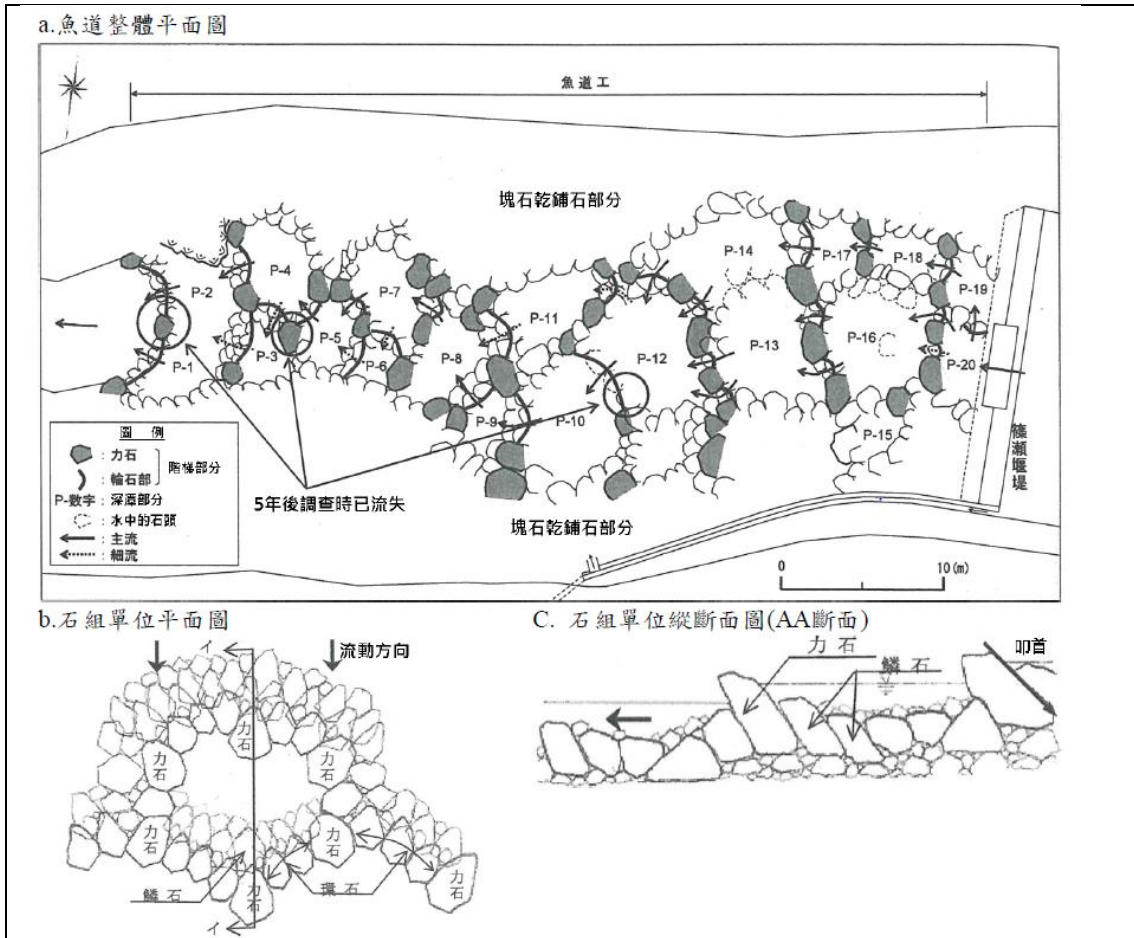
岩岳川篠瀨堰護床工採溪床復原型全断面魚道形式平面圖
